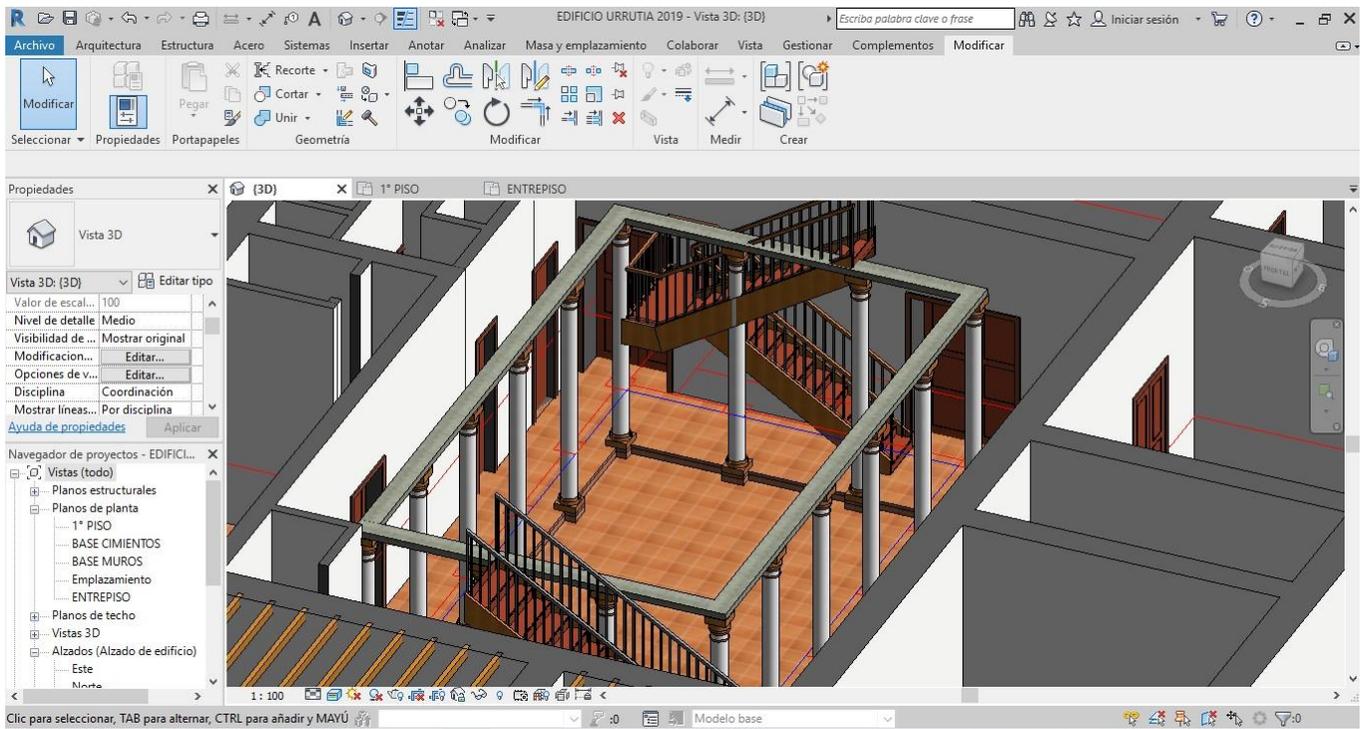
Columnas arquitectónicas y estructura entrepiso. (13)
